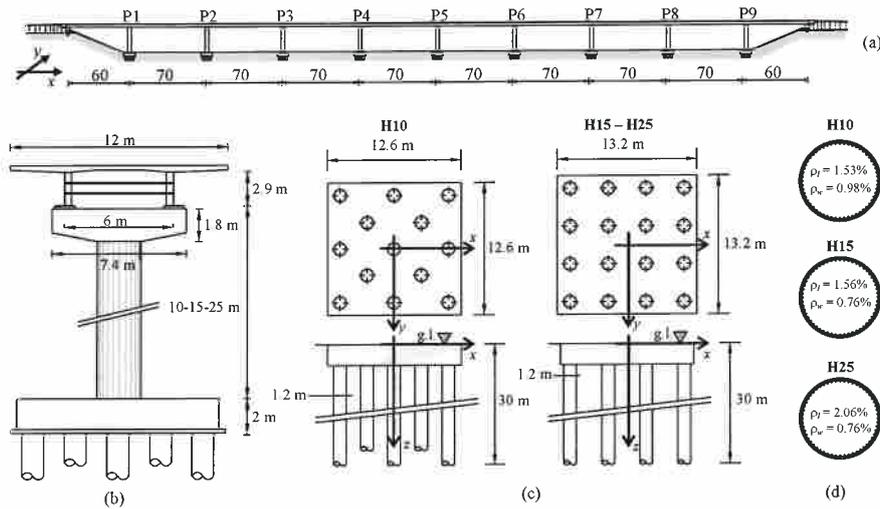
(a) Vista laterale del viadotto; (b) pila in elevazione; (c) fondazione (d) armature longitudinale e trasversale della pila
